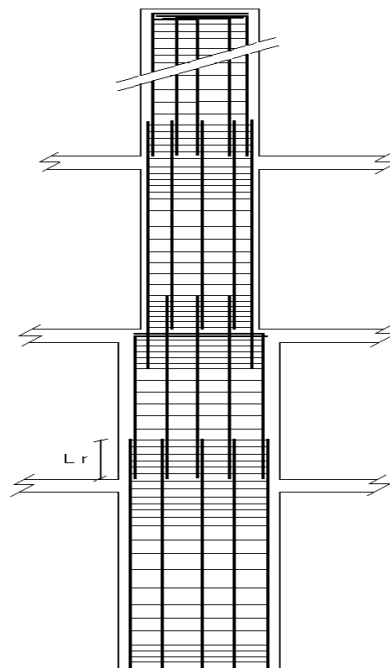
Coupe en élévation et détail de ferrailage des poteaux
